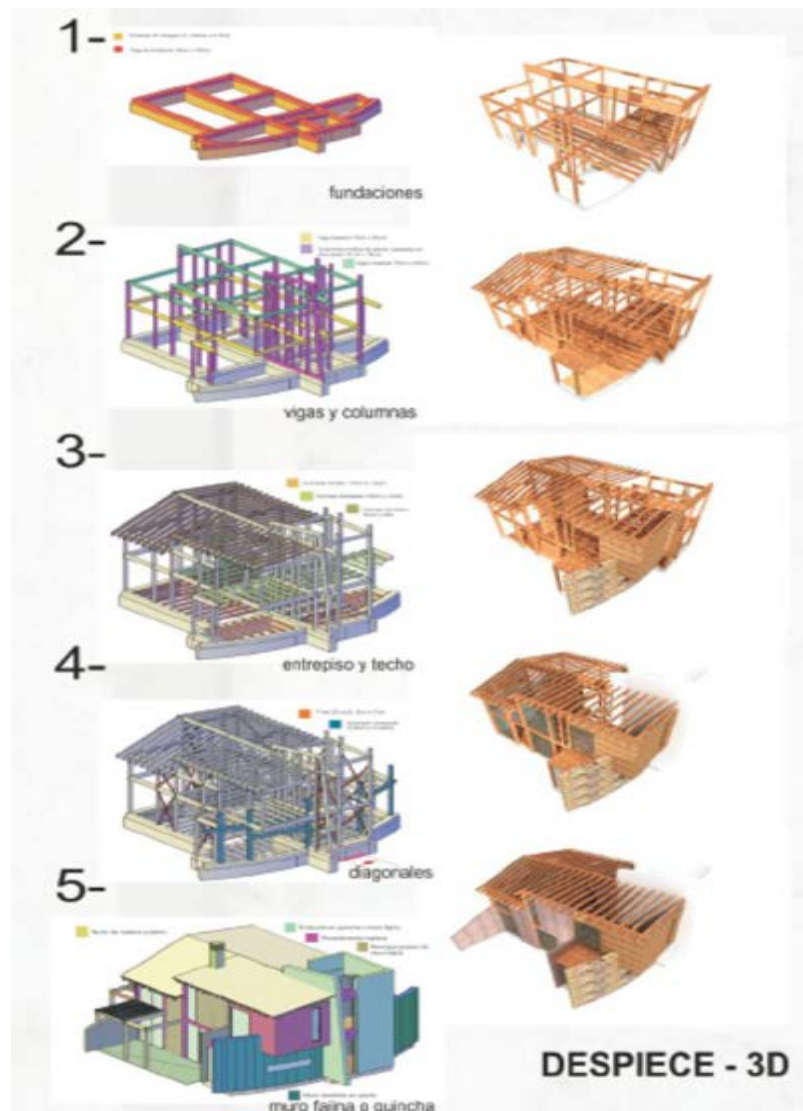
Vivienda familiar. Vivienda Bertini – Lavigna
